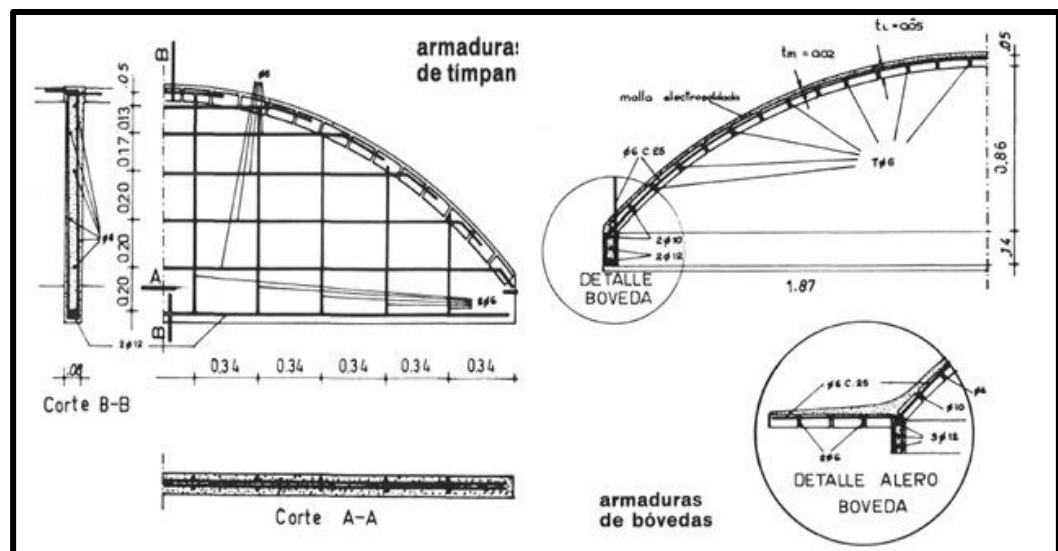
Detalle de Corte como referencia a la Armadura de la Cubierta
